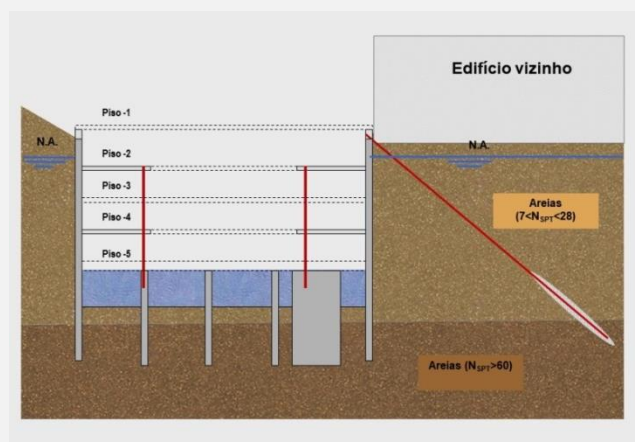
Perfil transversal de uma contenção de 5 pisos com painéis de parede moldada, escorados pelas lajes dos pisos, no edifício Baía, Luanda, 2018
